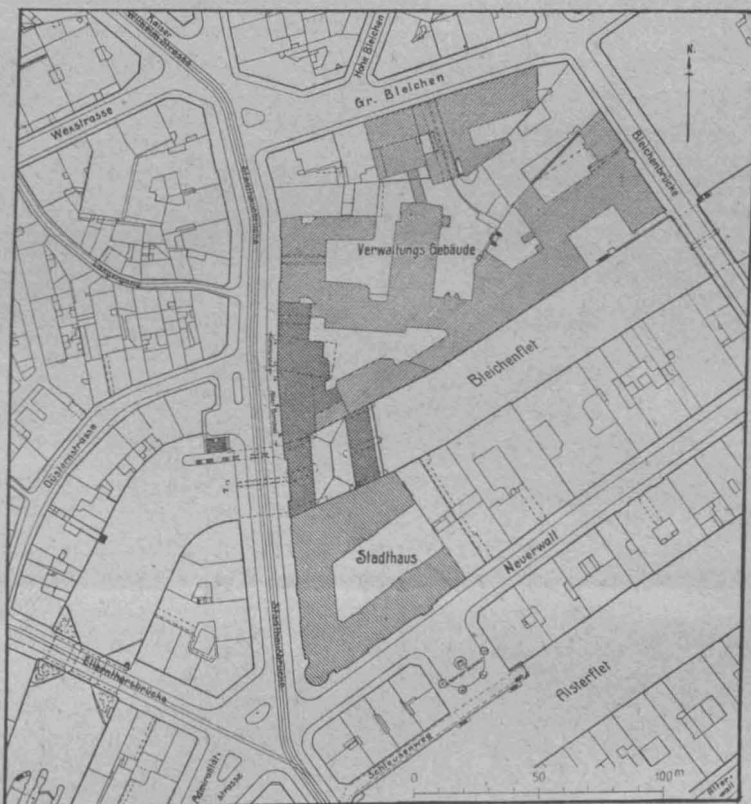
Lageplan des Stadthauses mit seinen Erweiterungen.
